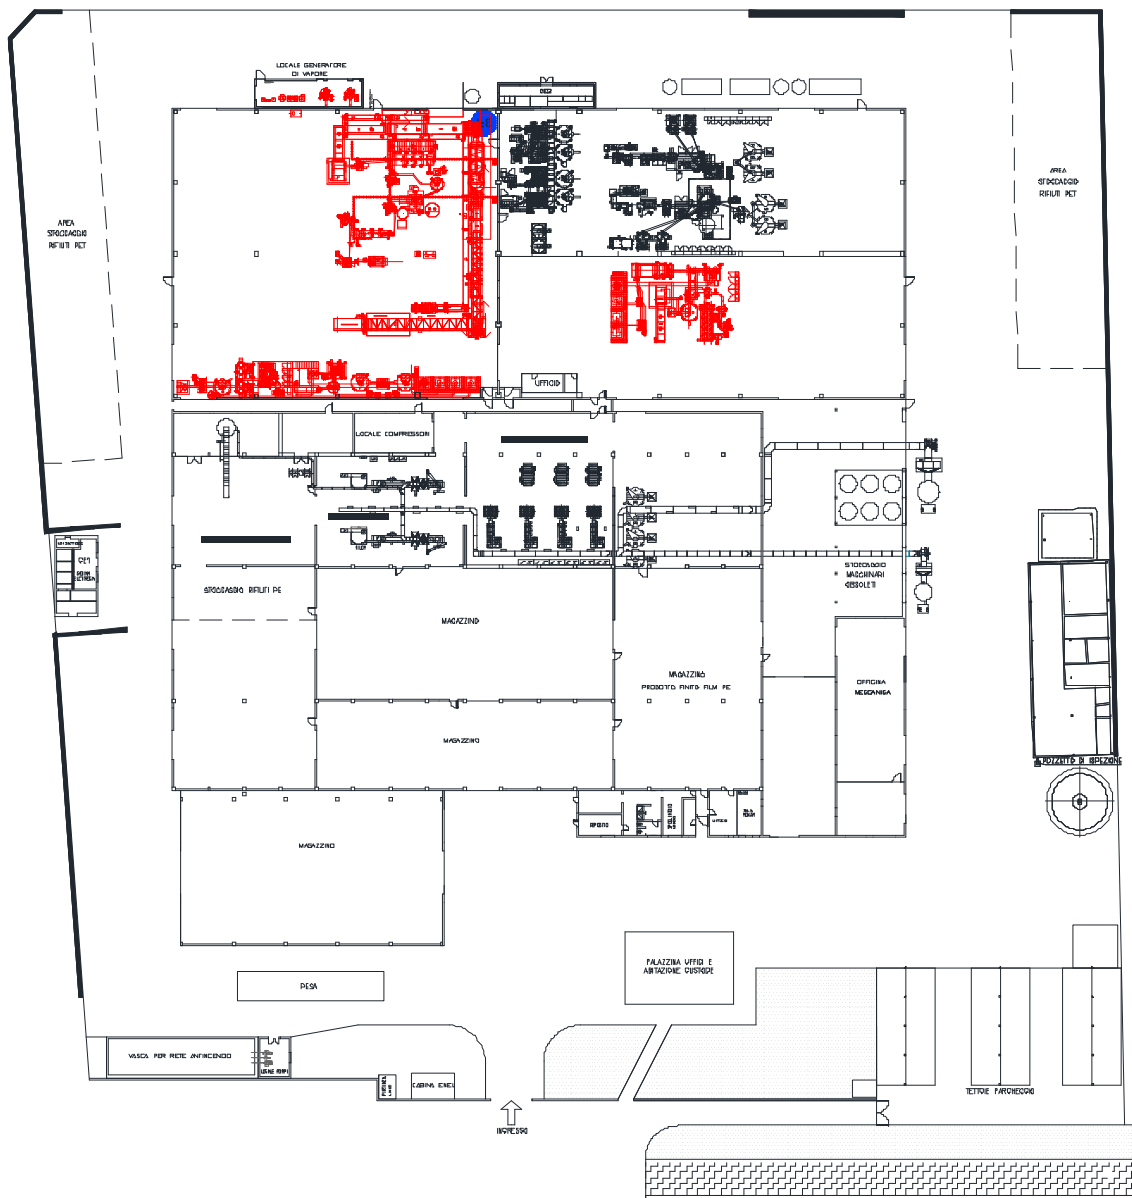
Planimetria dello stato di fatto. In rosso sono indicati gli impianti oggetto di modifica nel progetto di ampliamento.
